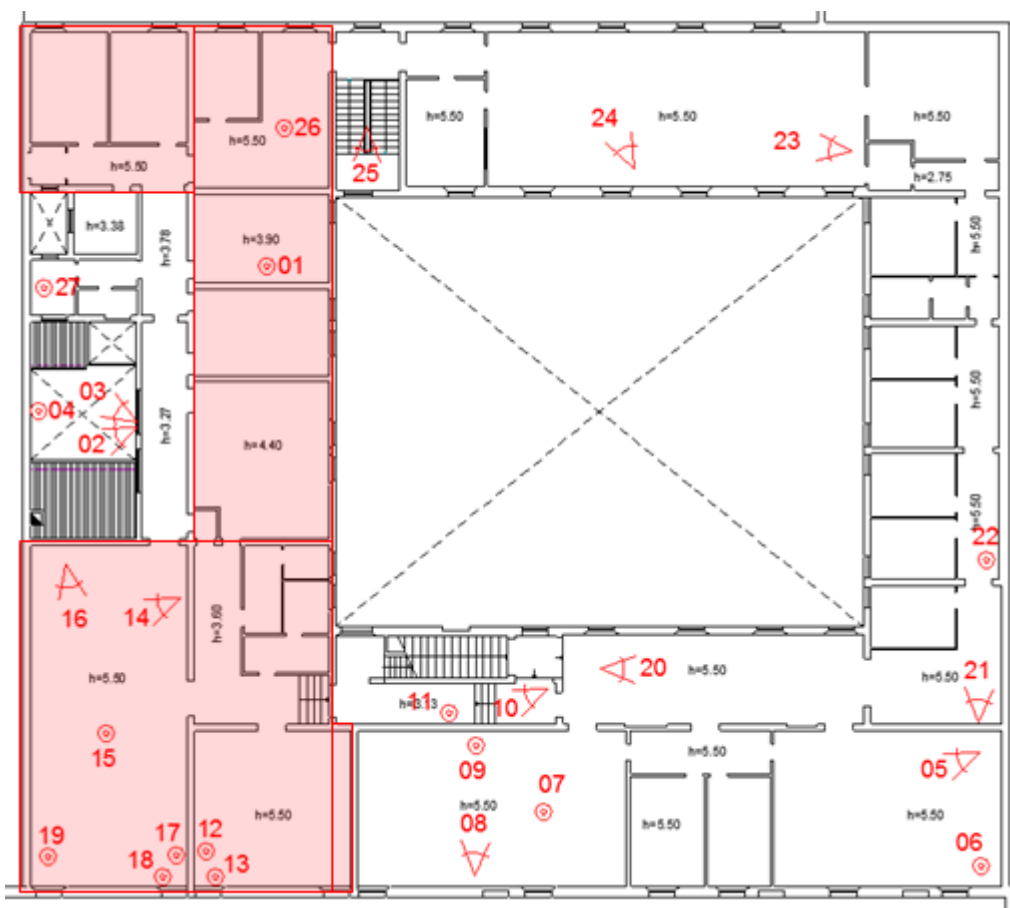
planimetria solaio di piano primo: indicazione dei solai sostituiti - intervento di restauro 1970
